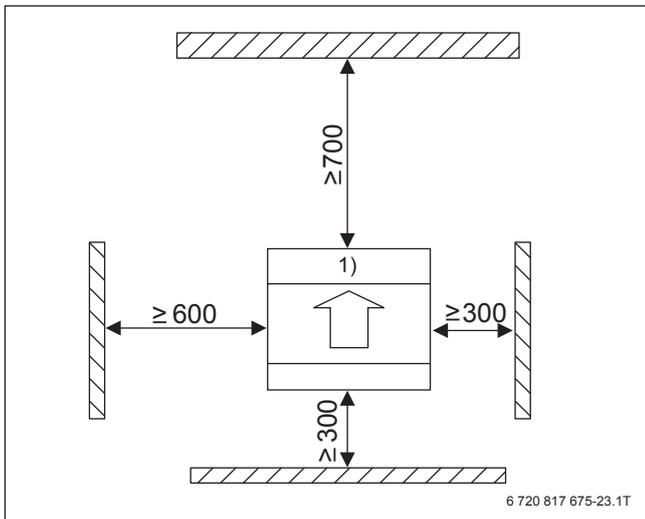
Mindestabstand Wärmepumpe – Umgebung (mm)
